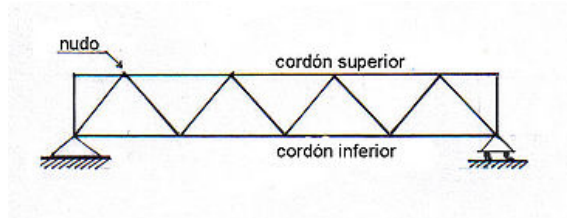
Vigas de Celosía. Fuente: <https://www.construmatica.com/> (2021)
